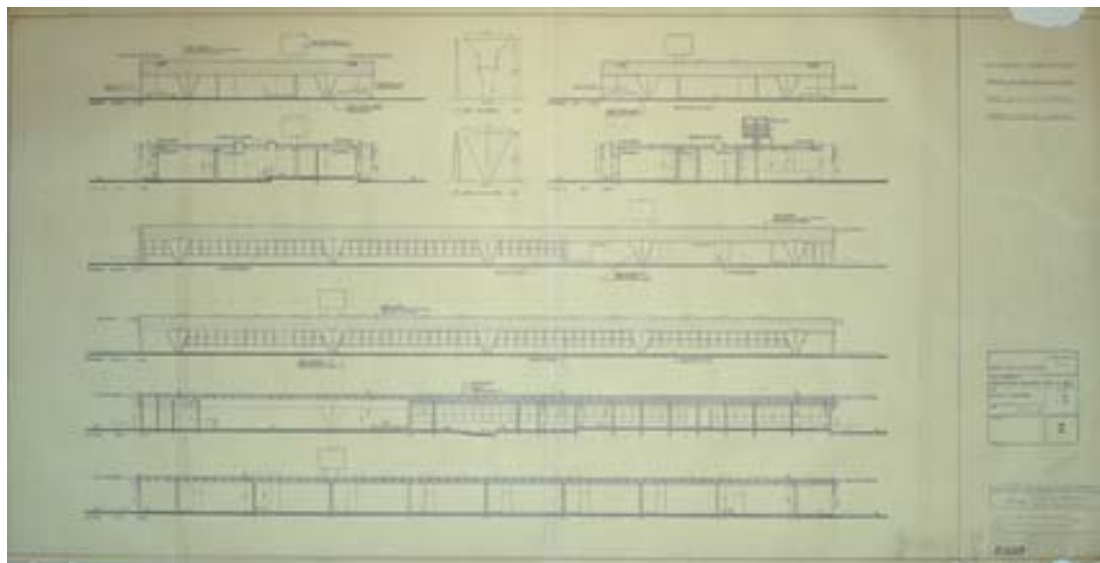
Abrahão Sanovicz, Grupo escolar Bairro Macuco, Santos: cortes, elevações e detalhes
